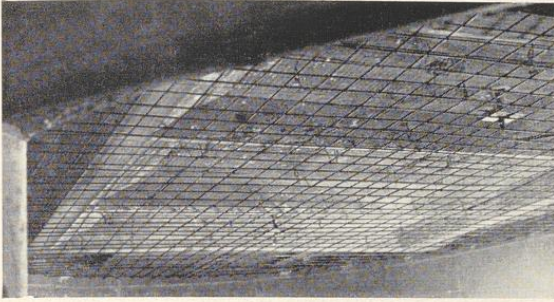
An Eisenbetondecke aufgehängte Rabitzkonstruktion
